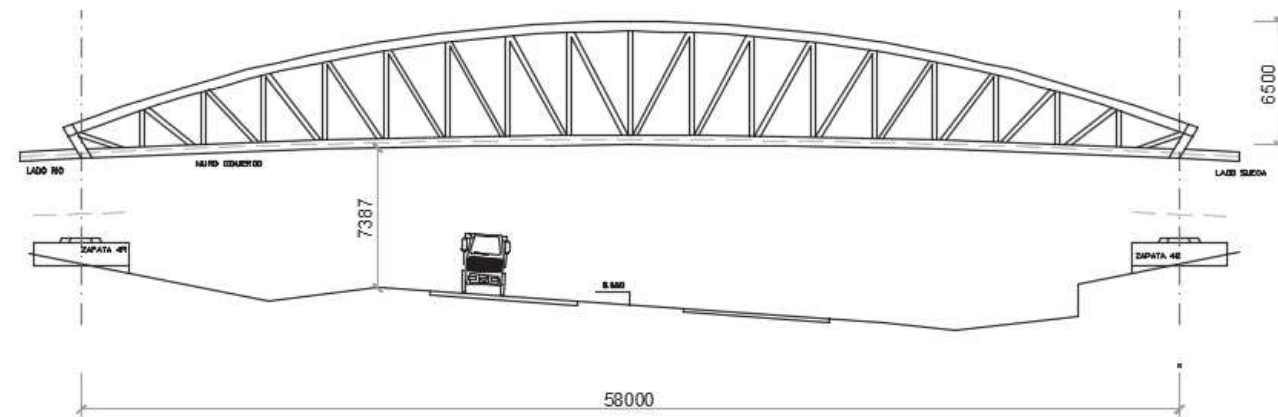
Solución B: Puente viga en celosía. Cotas en mm
